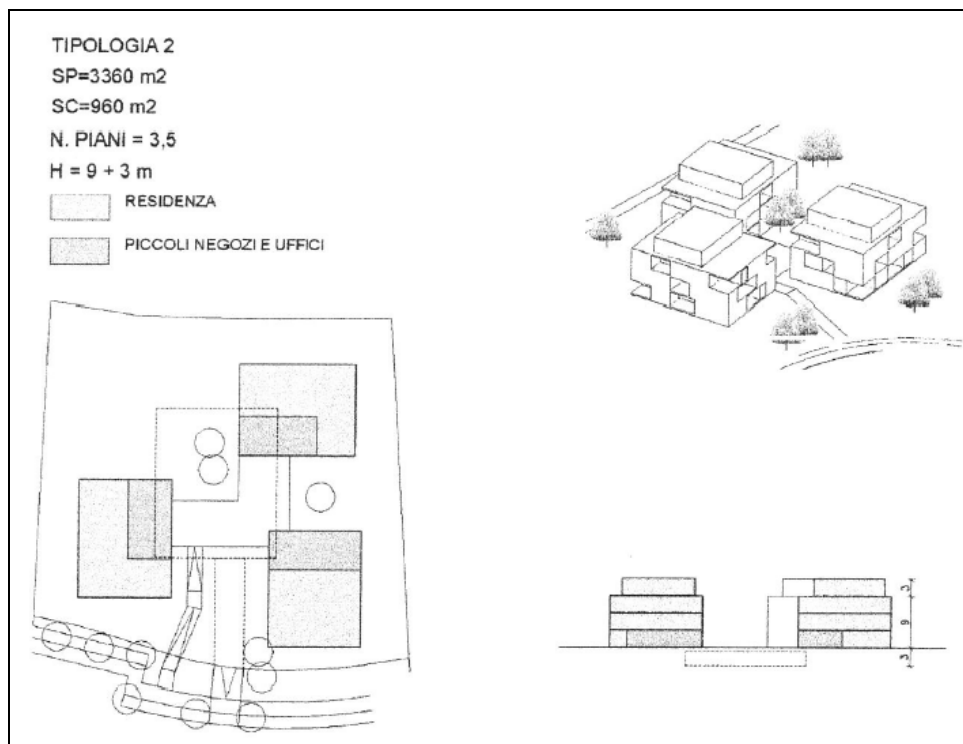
Estratto dalla Relazione tecnica del P.d.L. (Allegato 3)
